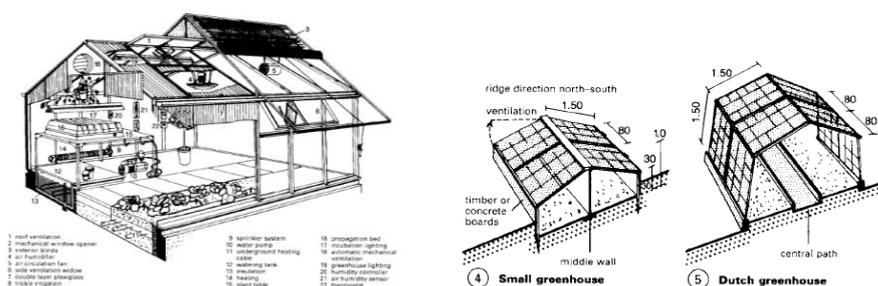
12 Struktur Kerangka Greenhouse Tipe Campuran
